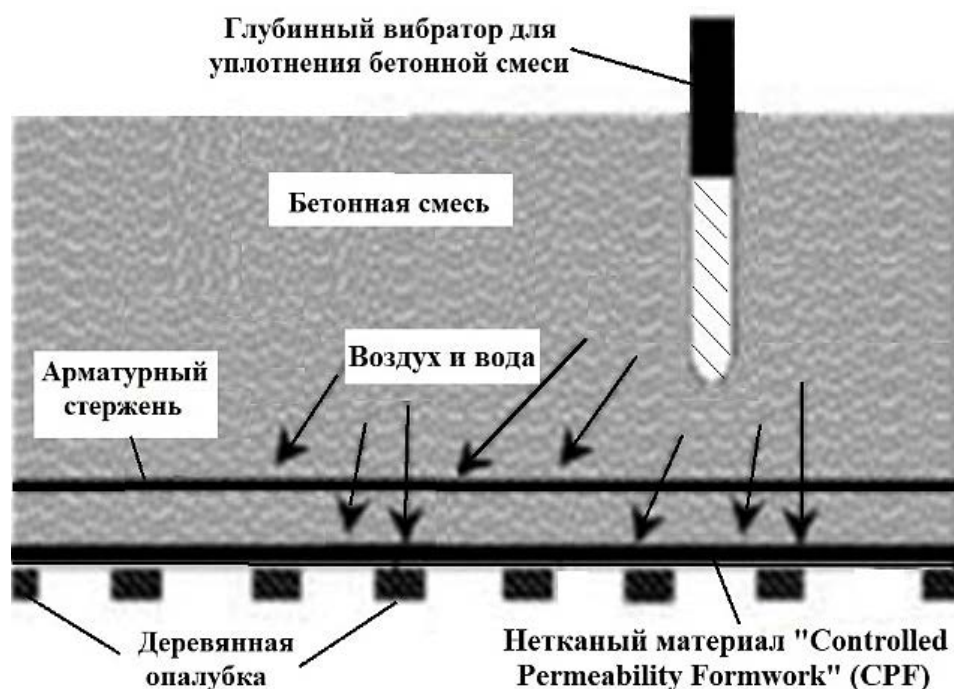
Принципиальная схема конструкции опалубки с использованием дренажного слоя из нетканного материала [5]
